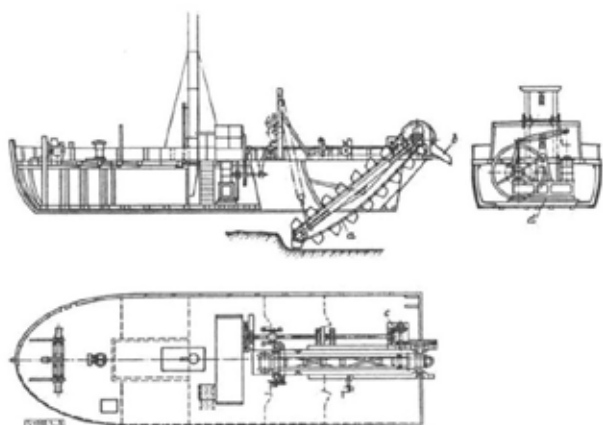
Erster in Deutschland 1841 gebauter Dampfbagger. Nach Heinz Conradis: Alte Baggermaschinen. In: Technikgeschichte 26 (1937), S. 58.
